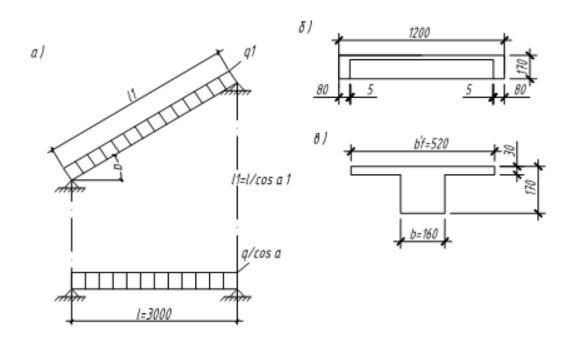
К расчету лестничного марша: а- расчетная схема; б, в- фактическое и приведенное поперечные сечения
